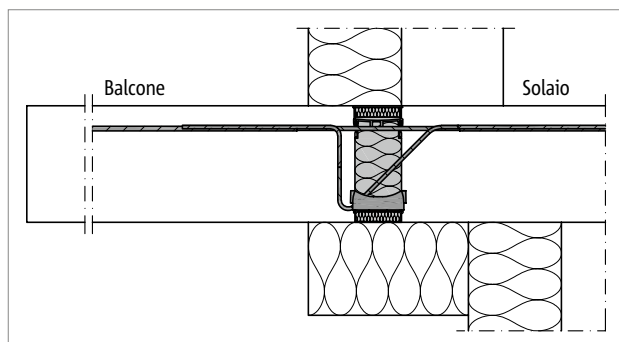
Schöck Isokorb® T tipo KL: raccordo indiretto a solaio con cappotto
